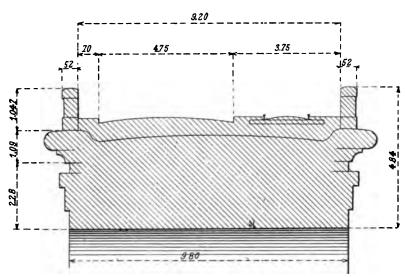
Pont de Gignac. — Coupe transversale actuelle.
